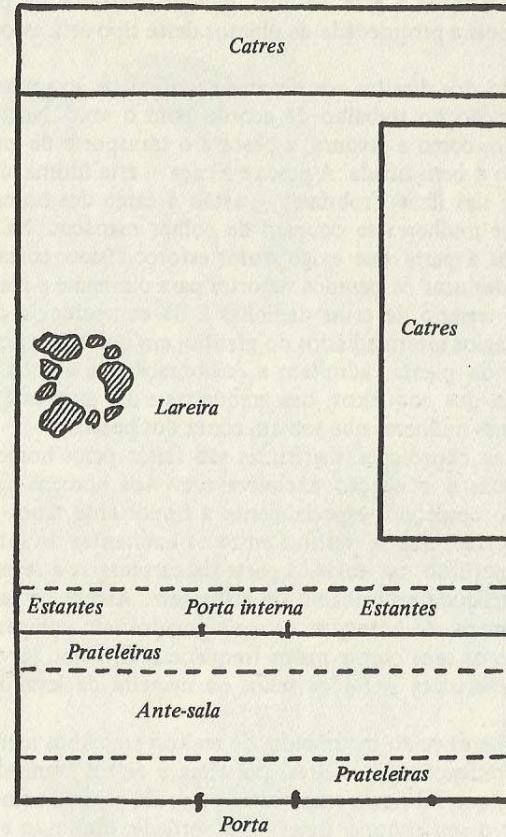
PLANTA DE UMA CASA DE MORADIA
